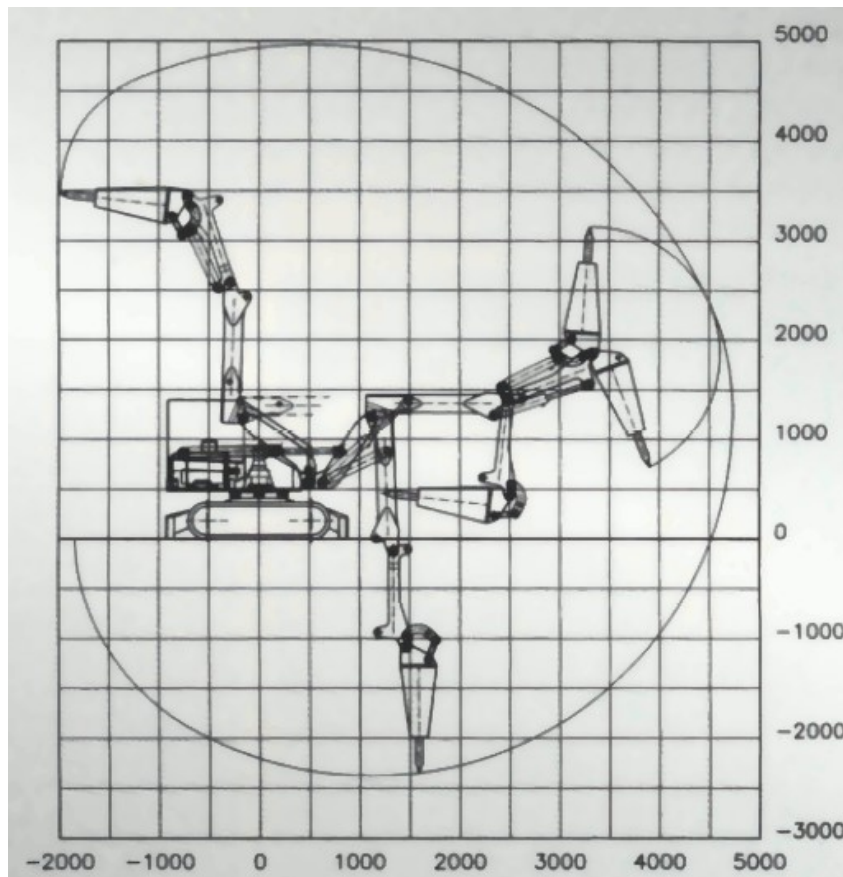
Arbeitsbereich für angeflanschte Werkzeuge /11/
